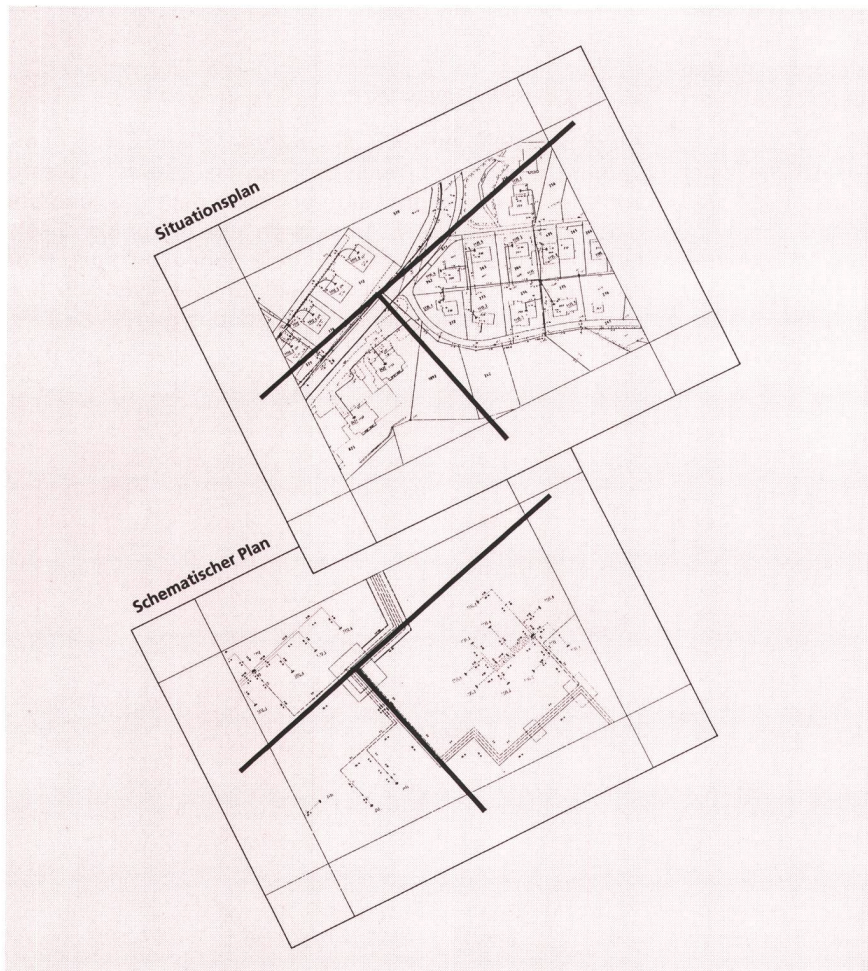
Der Situationsplan als Grundlage für den schematischen Plan; Übertragen der Hauptachsen – Le plan de situation, document de base pour le plan schématique; report des axes principaux
